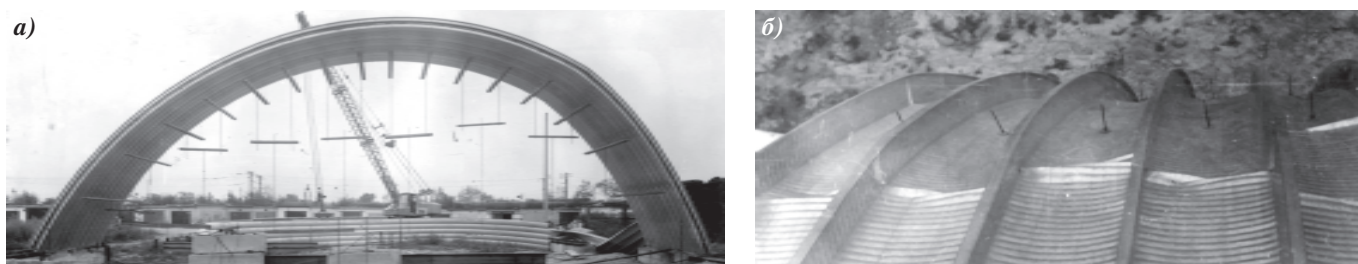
Натурные испытания фрагмента бескаркасного арочного покрытия пролетом 21 м
